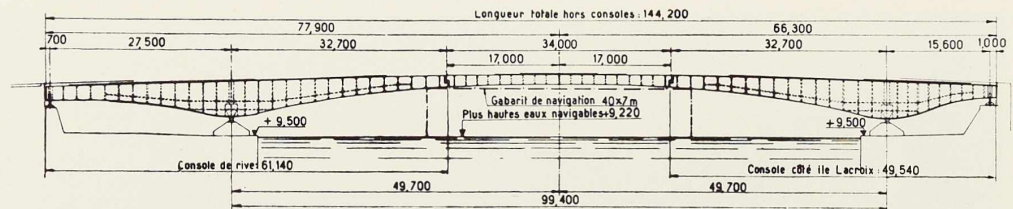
Elévation du nouveau pont Corneille à Rouen.
